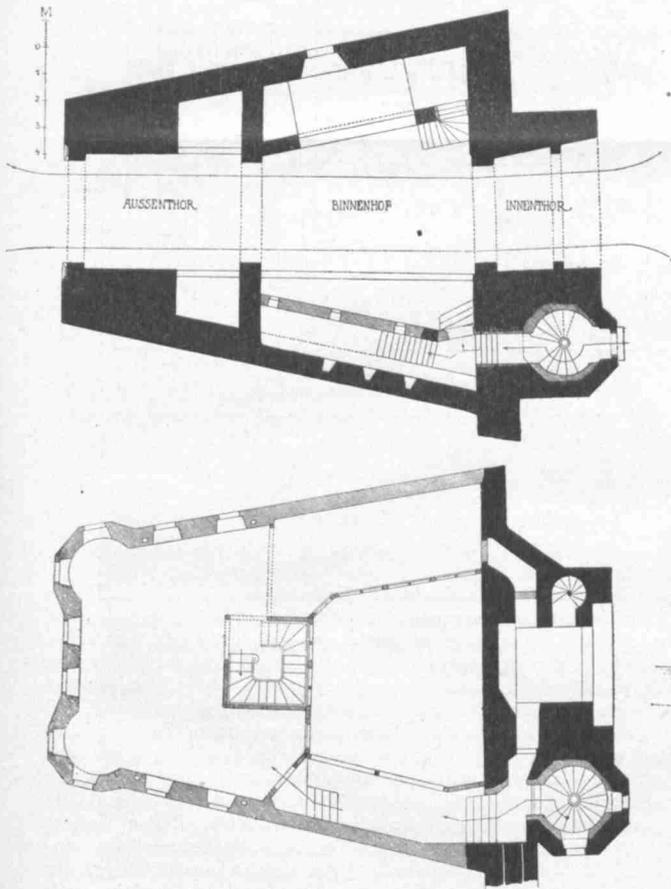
u. 4. Grundrisse des Erdgeschosses und des Obergeschosses nach der Wiederherstellung.
